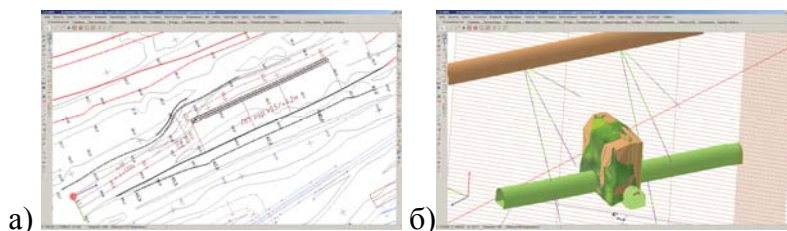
Проектные решения: а) проектирования перегрузочной площадки; б) проектирование отработки залежи подэтажными штреками.
